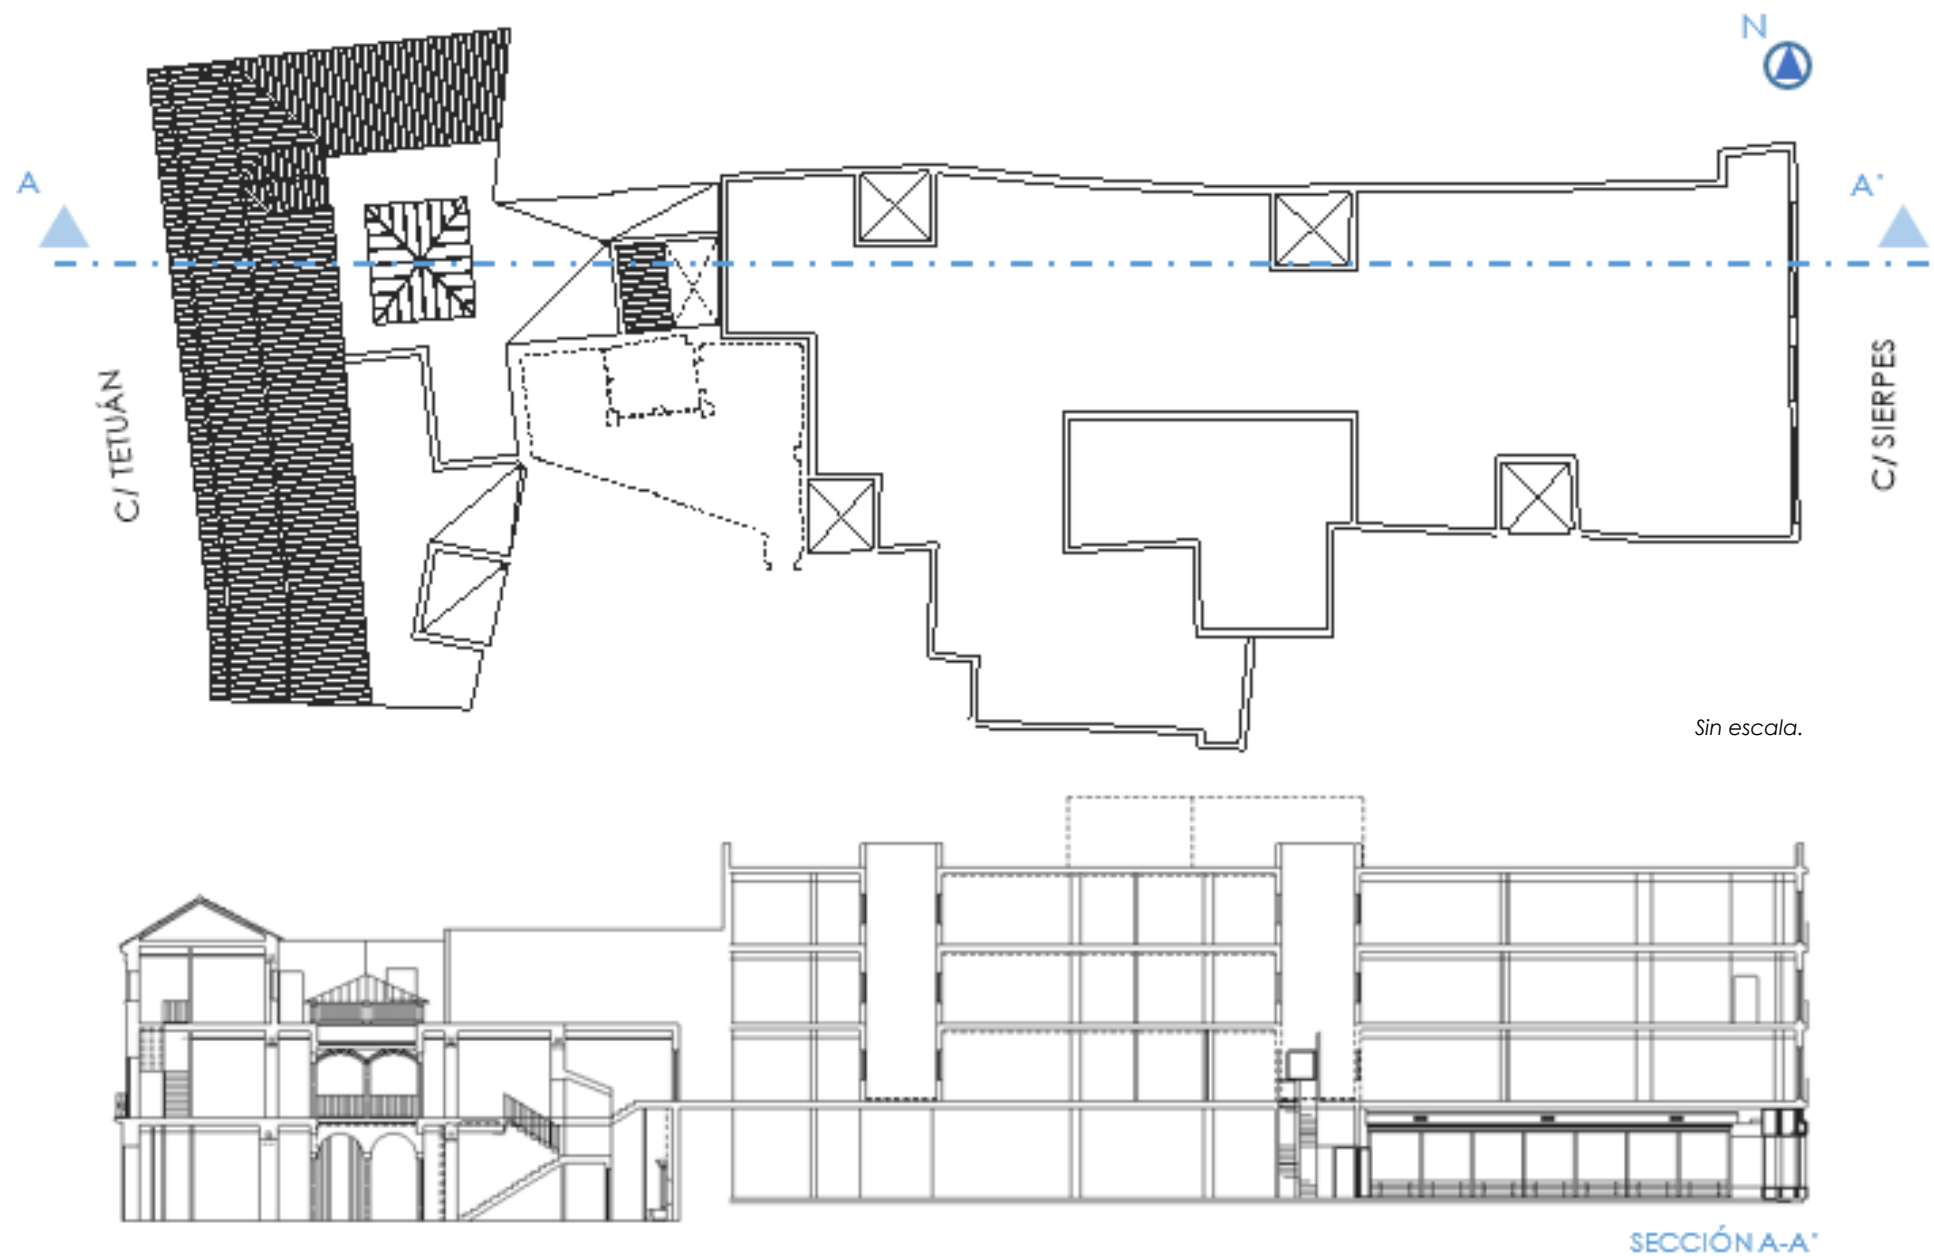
Delineación del conjunto Tetuán-Sierpes. Planta y Sección.
